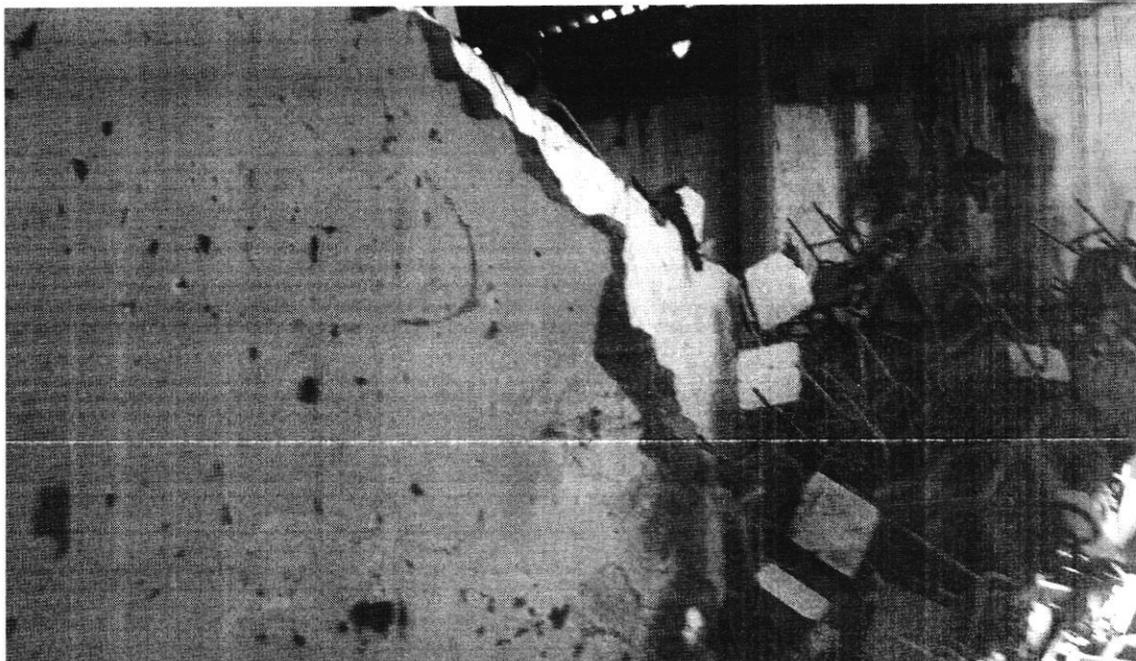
DETALHE ENCONTRO DA PAREDE QUE SERA DEMOLIDADA COM A PAREDE DA FACHADA PRINCIPAL – LADO INTERNO
